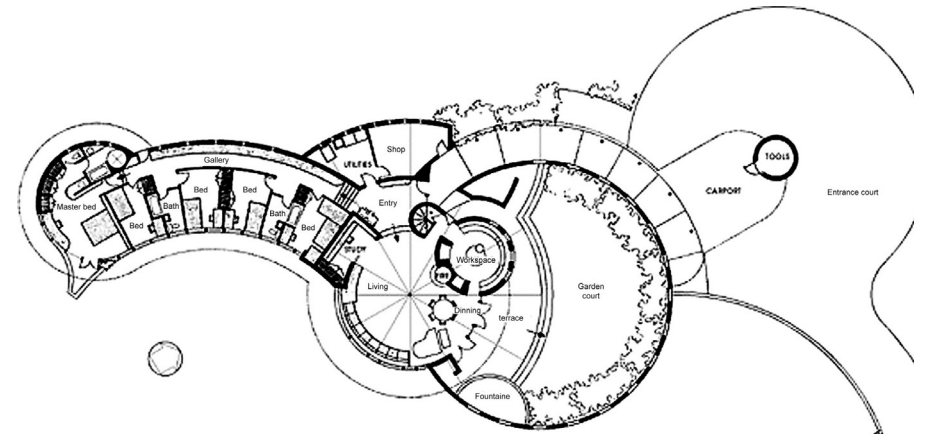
(arriba) y 39: Planta y Vista aérea. Norman Lykes House. Arizona, 1959-1967.
